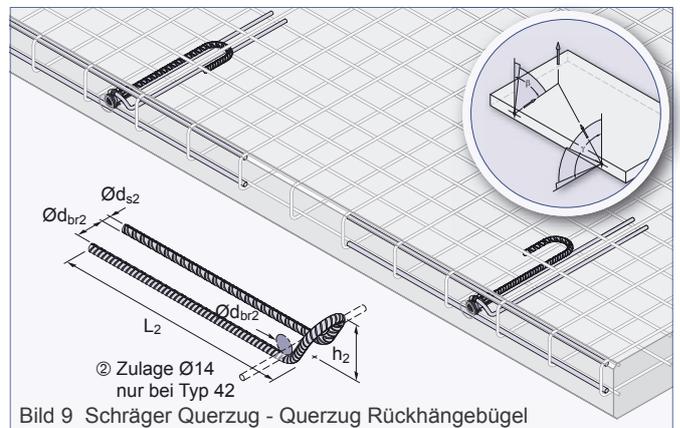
Schräger Querzug - Querzug Rückhängebügel
